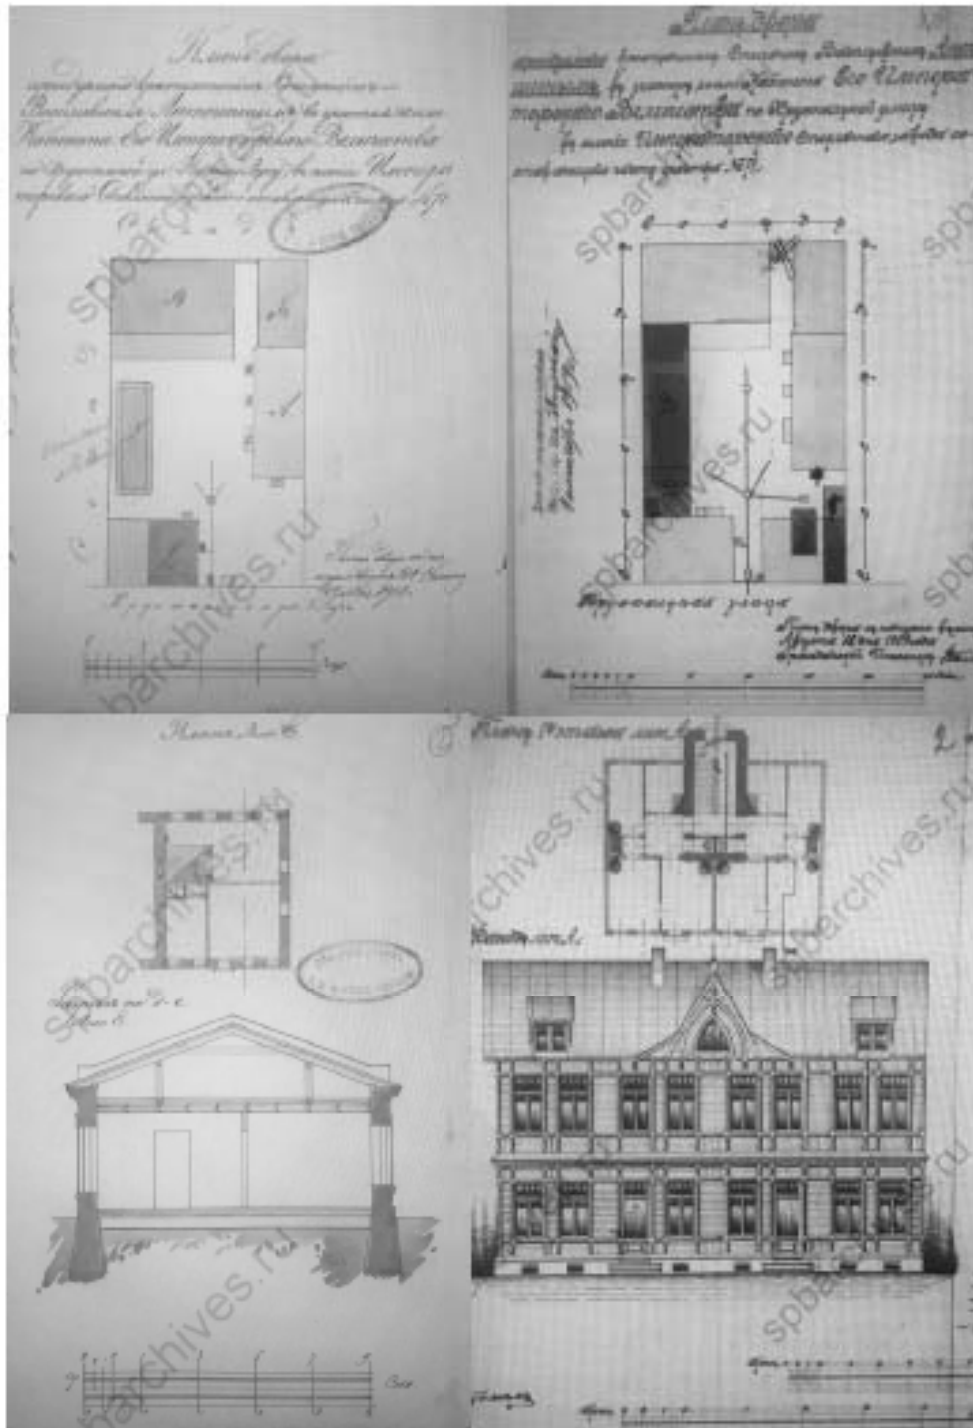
План участка, фасад и разрез здания по адресу Хрустальная ул., 14
